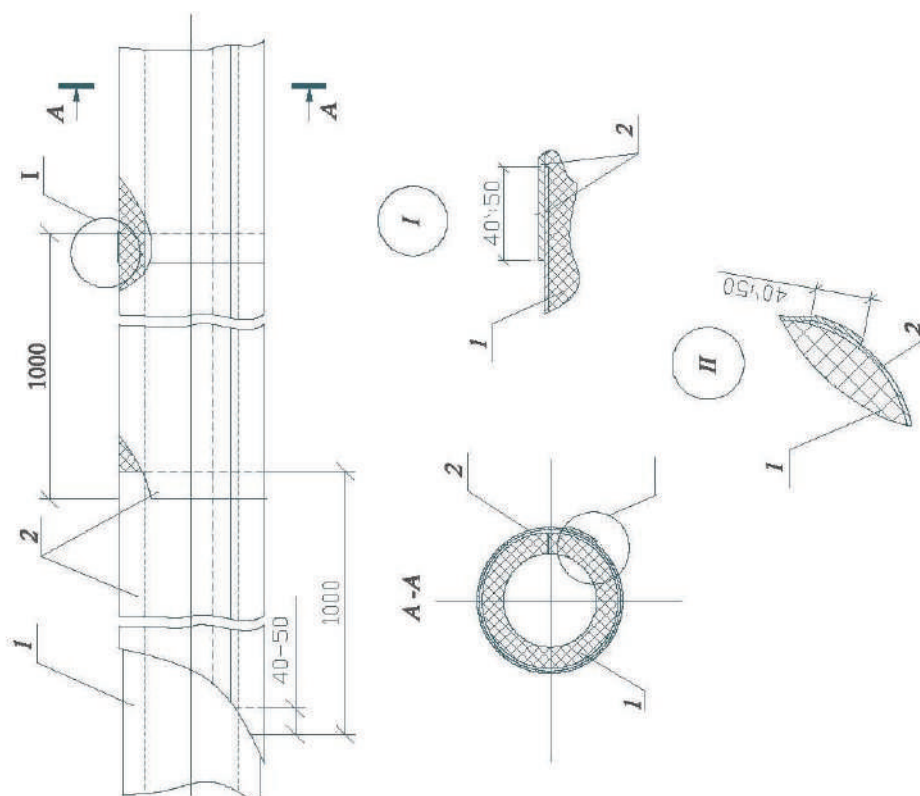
Тепловая изоляция трубопроводов изделиями с покрытиями FG, Metal Pro или Protape при расположении на открытом воздухе
